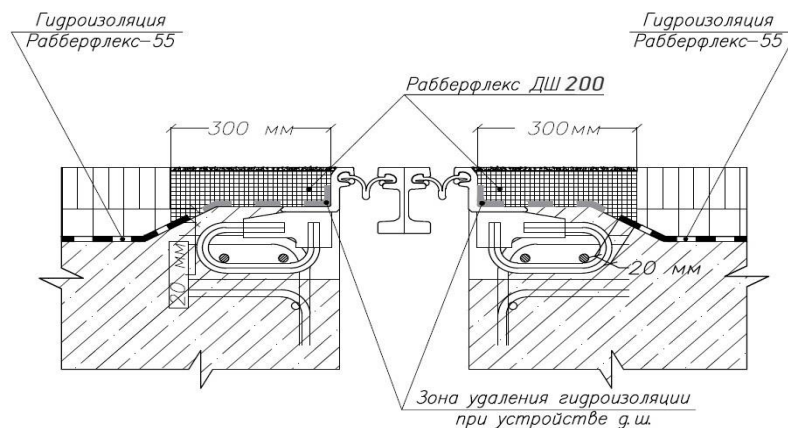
Схематическое изображение зоны сопряжения асфальтобетонного покрытия с деформационным швом с металлическим окаймлением на железобетонном пролётном строение.
